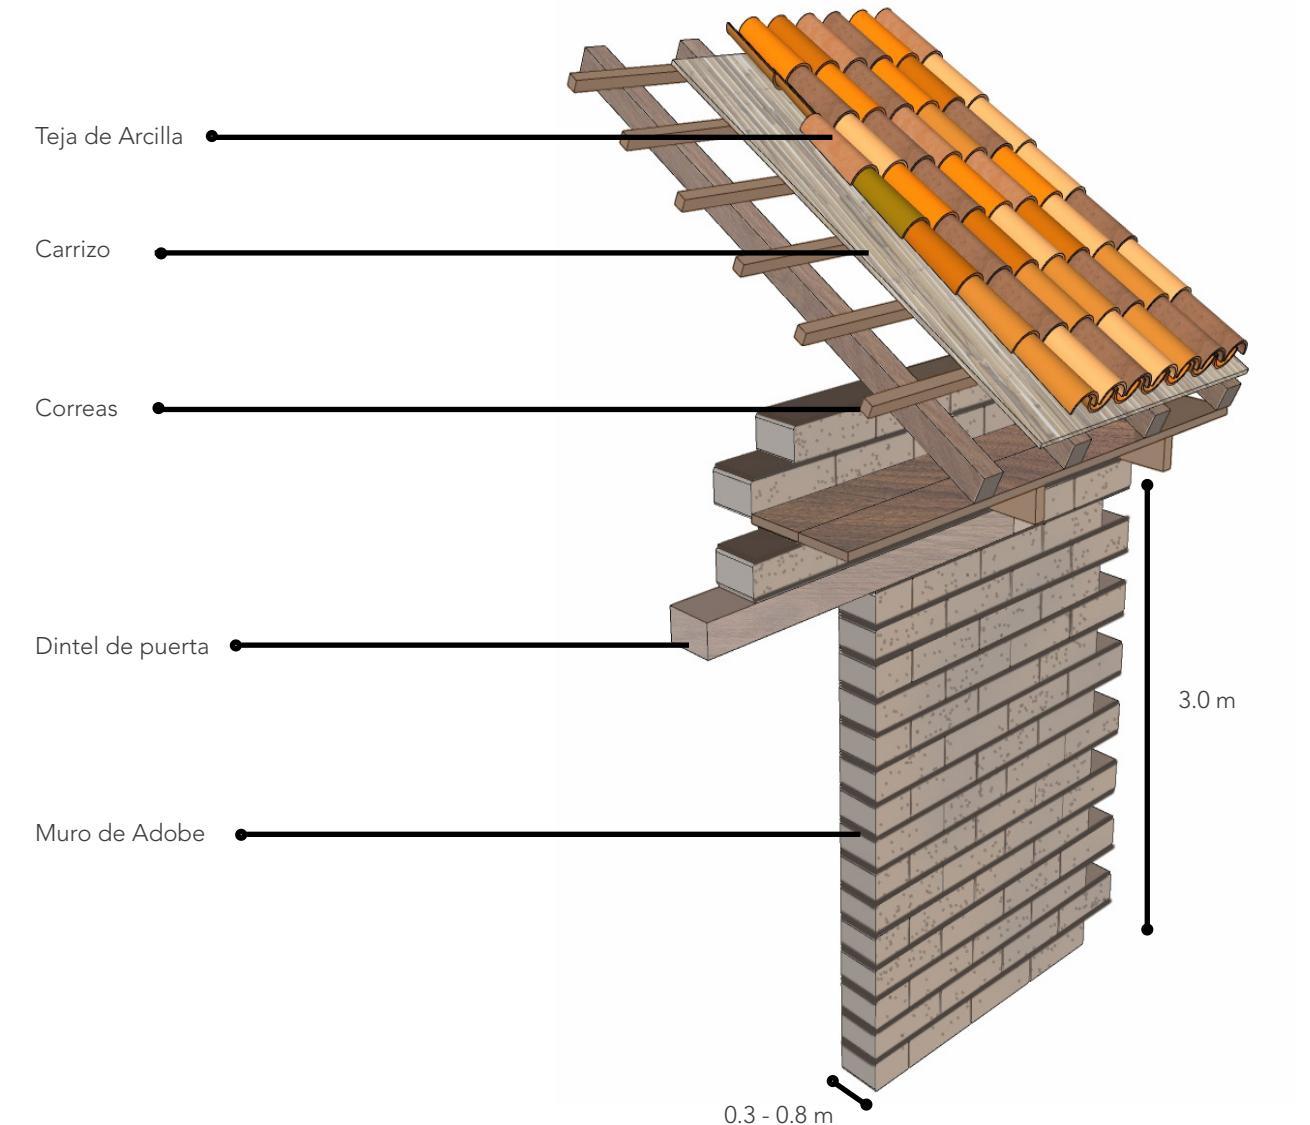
Detalle constructivo pared y techo de casa del adulto mayor - Elaborado por el autor.
